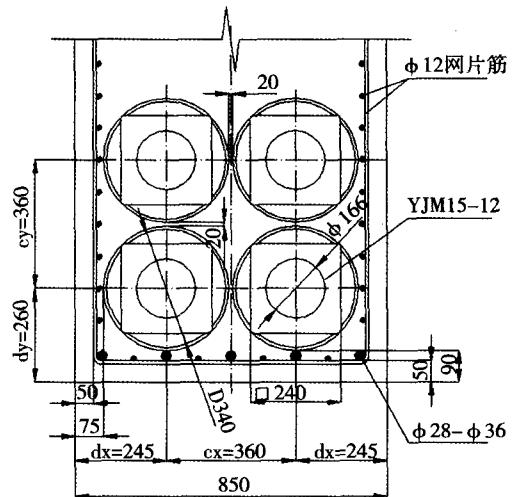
一种紧凑排列的4束预应力配筋锚固端布置图
